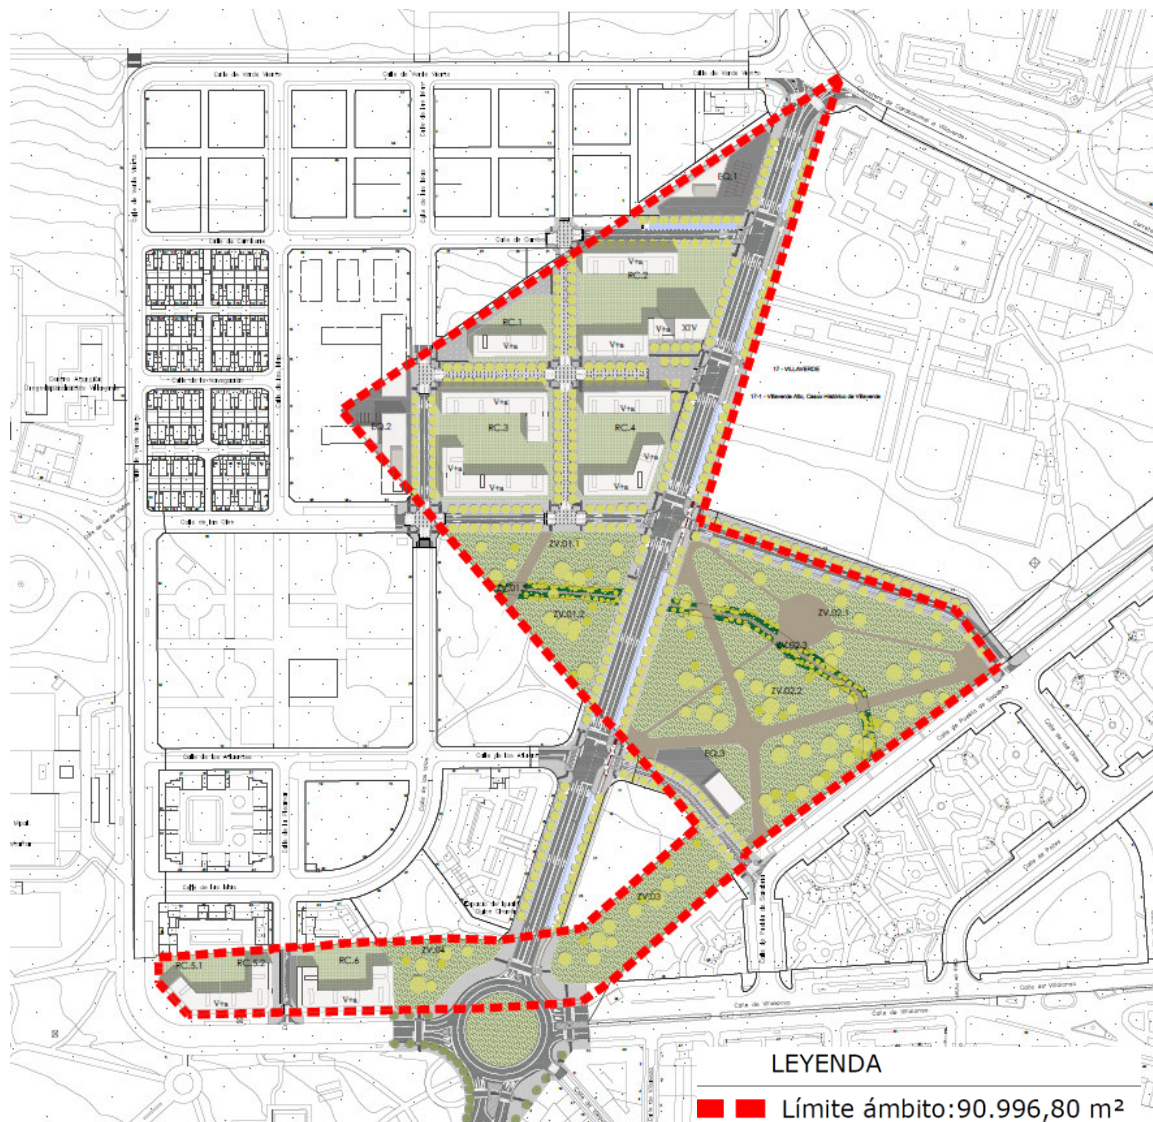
Detalle del plano *PO-06 Imagen final no vinculante
